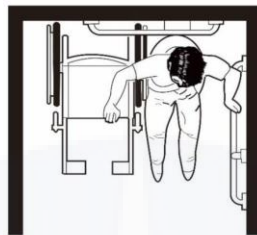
70 Denah 1 unit toilet siswa (putra/putri)
